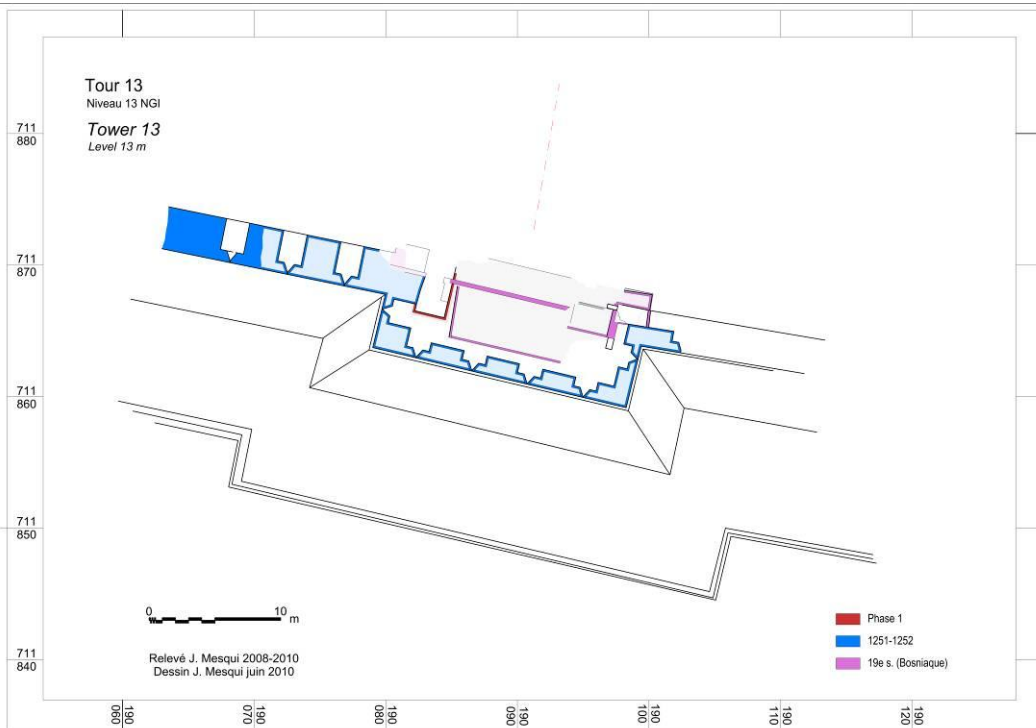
Plan de la tour T13 au niveau 13 m ASL
